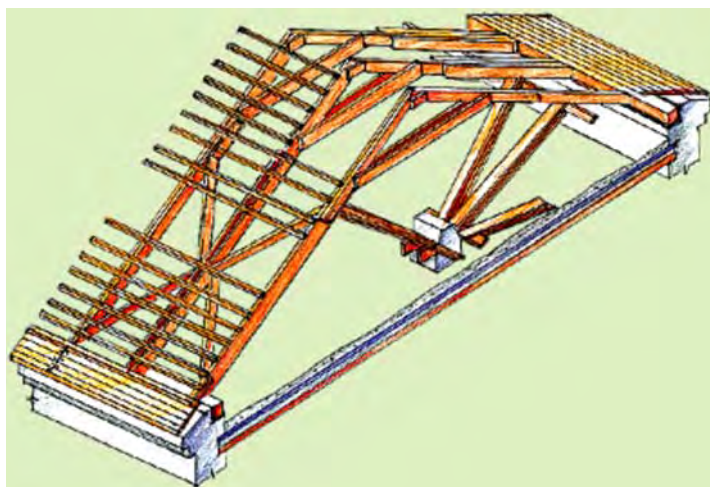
Наслонные стропила устанавливают в домах со средней несущей стеной или столбчатыми опорами
